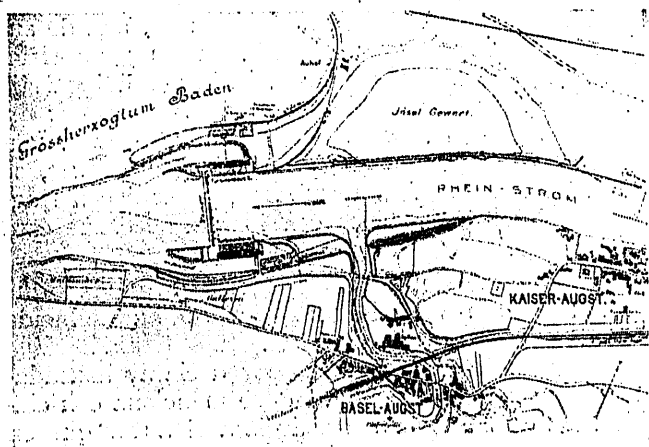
Plano de conjunto de la instalación de Augst-Wyhlen.
